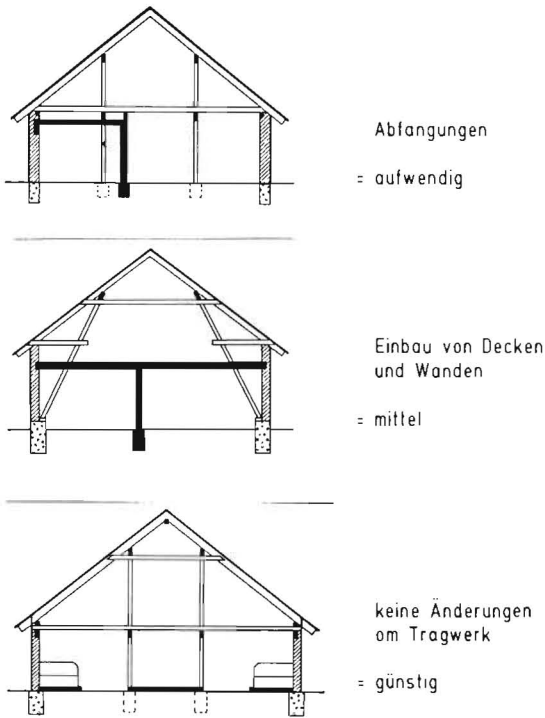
Um- und Ausbau vorhandener Gebäude – Konstruktive Maßnahmen
